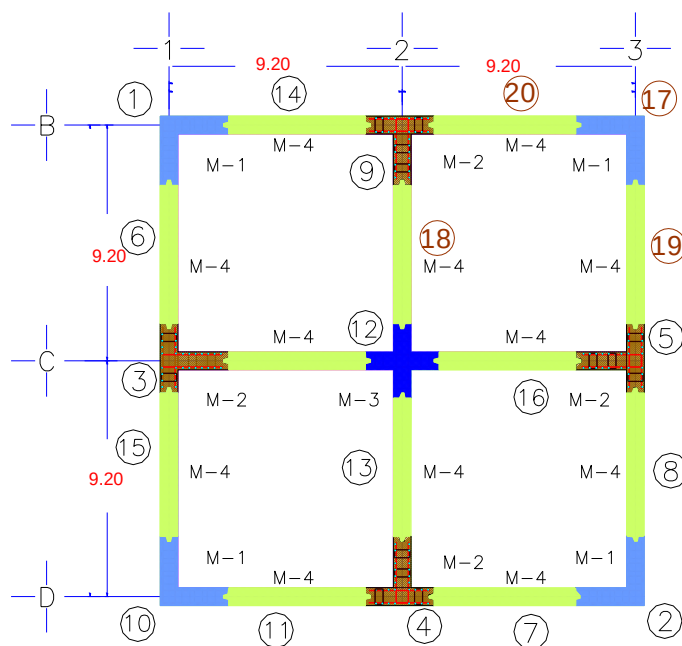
Planta de cimentación con la secuencia del proceso de construcción de los elementos del muro
